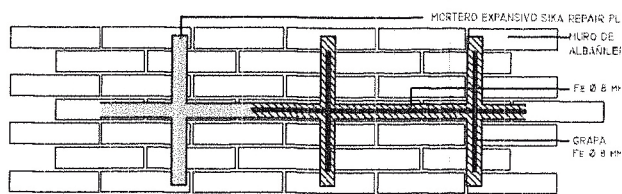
Refuerzo Mediante Grapas Grietas Horizontales
